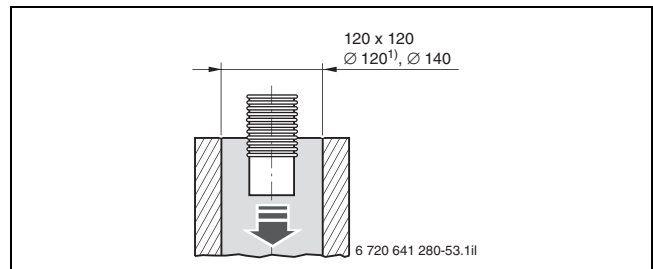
Mindestmaße des Schachtquerschnitts für die Montage der flexiblen Abgasleitung (Maße in mm)
